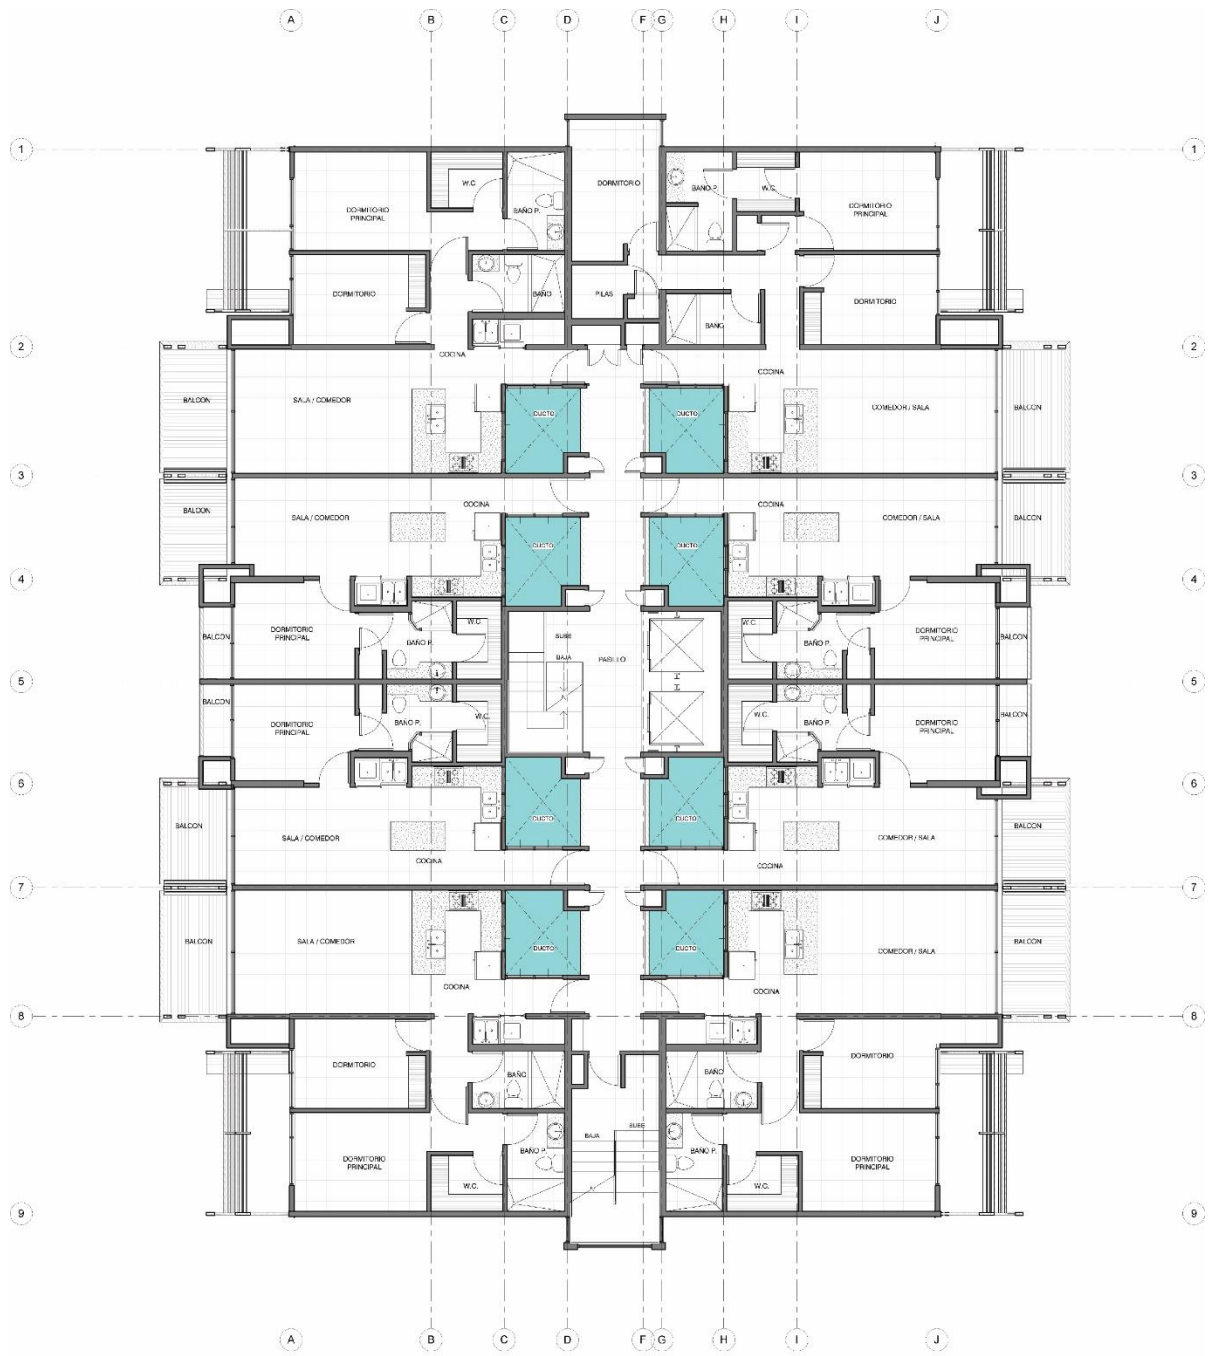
Rediseño de Planta Arquitectónica Nivel 2° al 6°. Fuente: Elaboración propia
